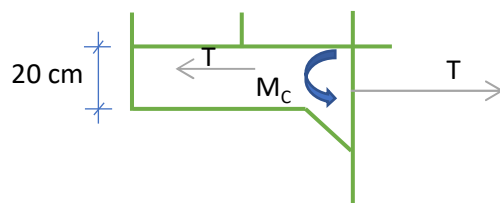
Fuerza de tensión axial actuante en losa en voladizo
